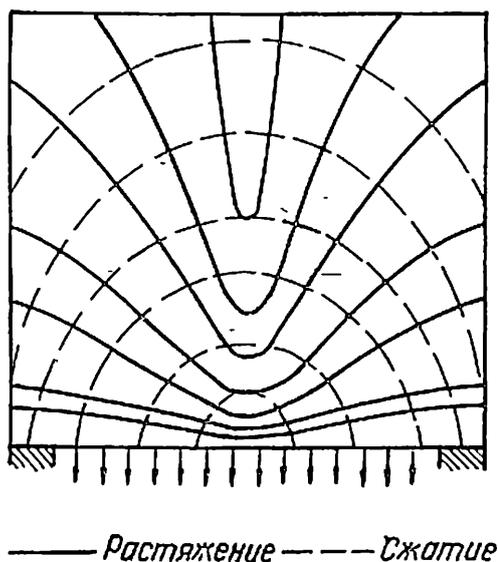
II,а: Траектории главных напряжений у балок-стенок при подвесной нагрузке ($l/h = 1$)
